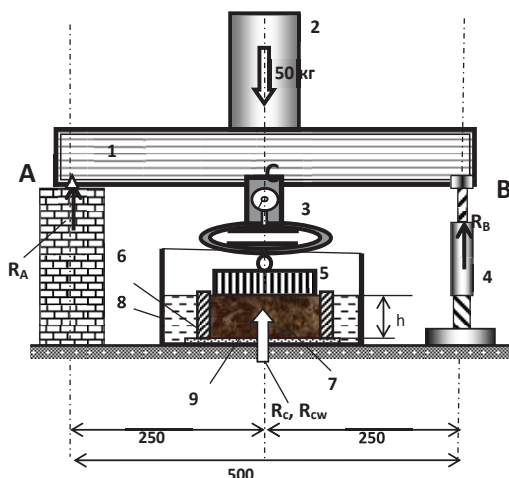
Схема испытательного стенда для исследования влияния локальной зоны увлажнения грунтов на изменение реактивного отпора грунта под подошвой фундамента
